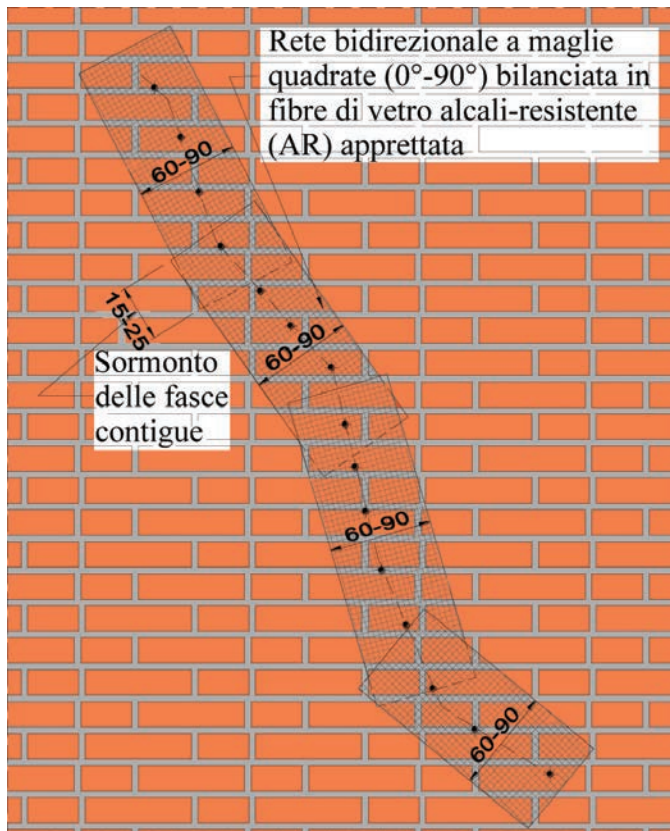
Applicazione di rete di rinforzo: vista prospettica.
